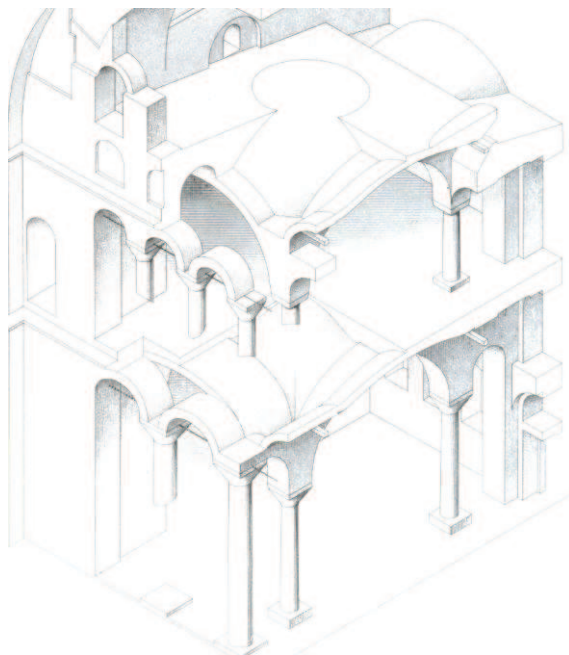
Santa Sofía. Naves laterales. (Choisy).
